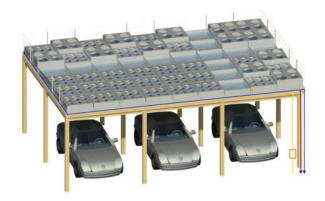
Carport-Dachbegrünung - Wasserbecken mit installierten HPL® Pflanzmodulen
